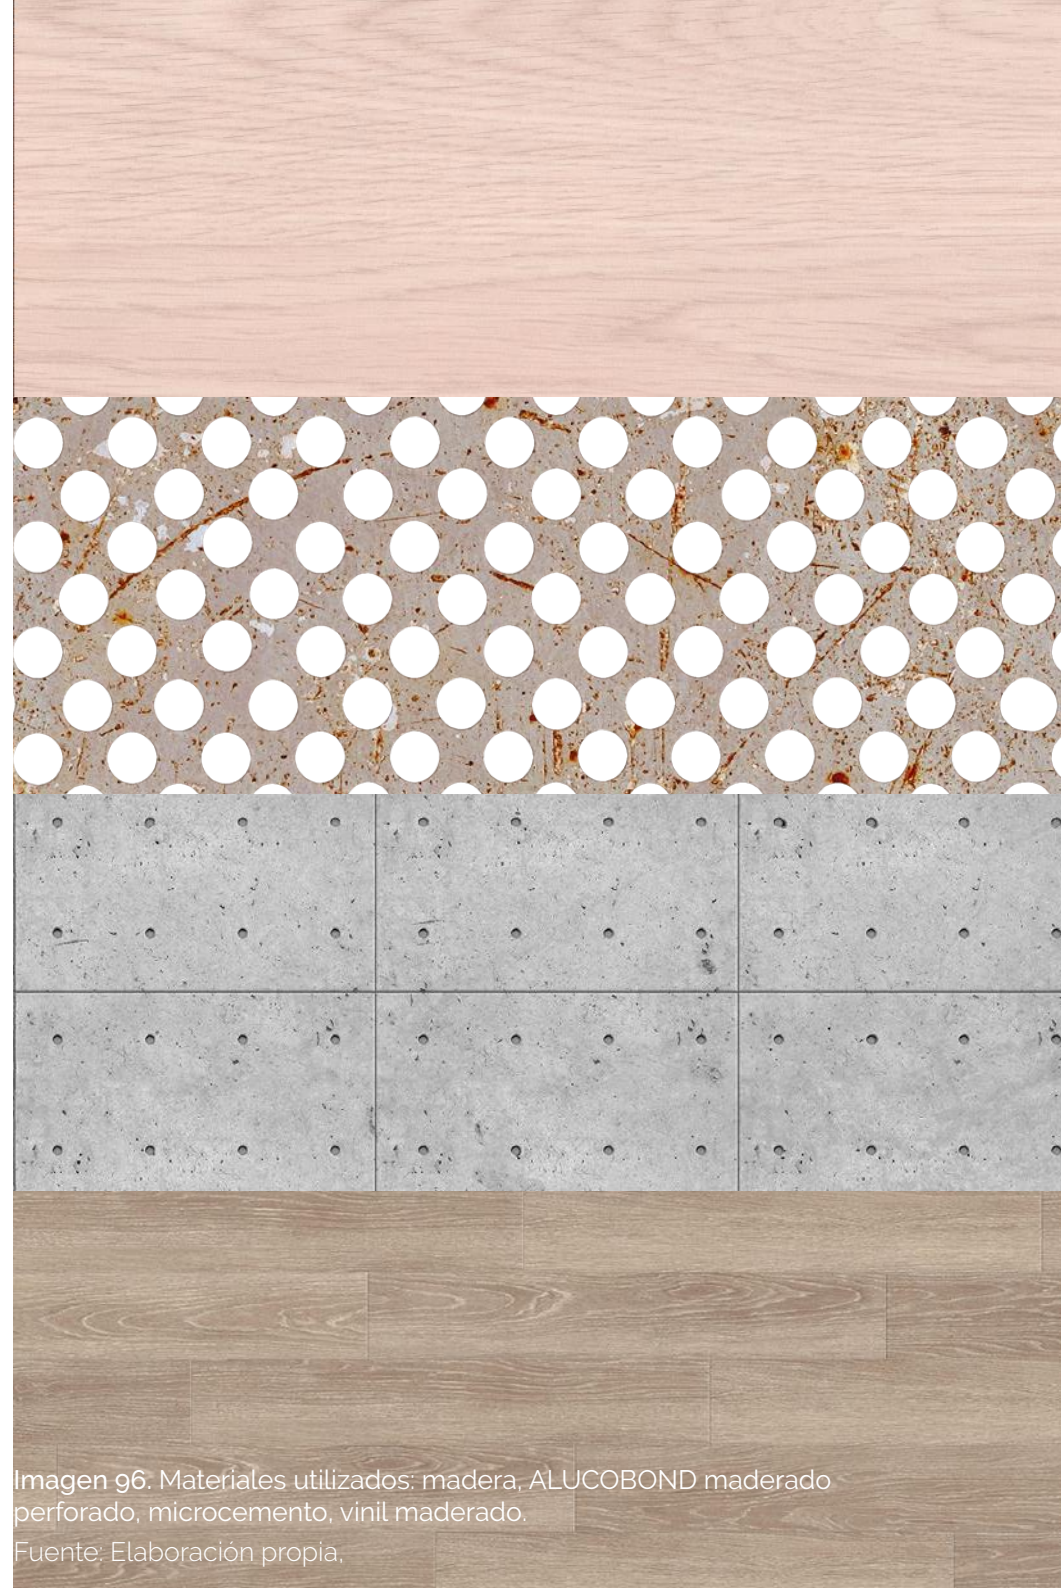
Materiales utilizados: madera, ALUCOBOND maderado perforado, microcemento, vinil maderado.
